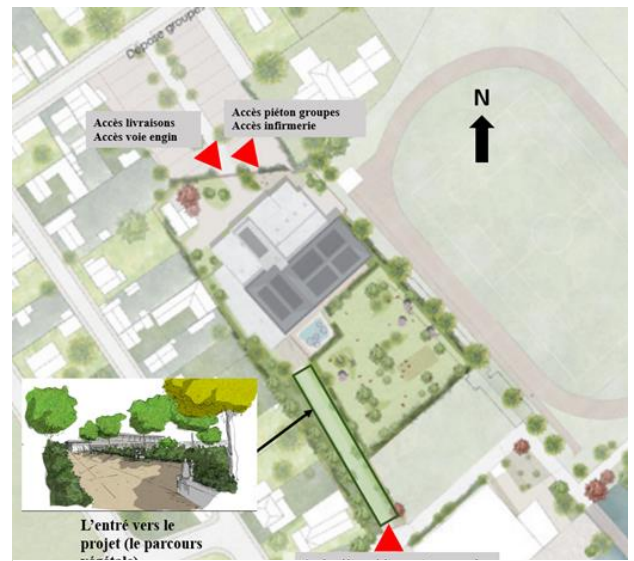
Plan de masse traité par auteur source : sudarchitectes.com
